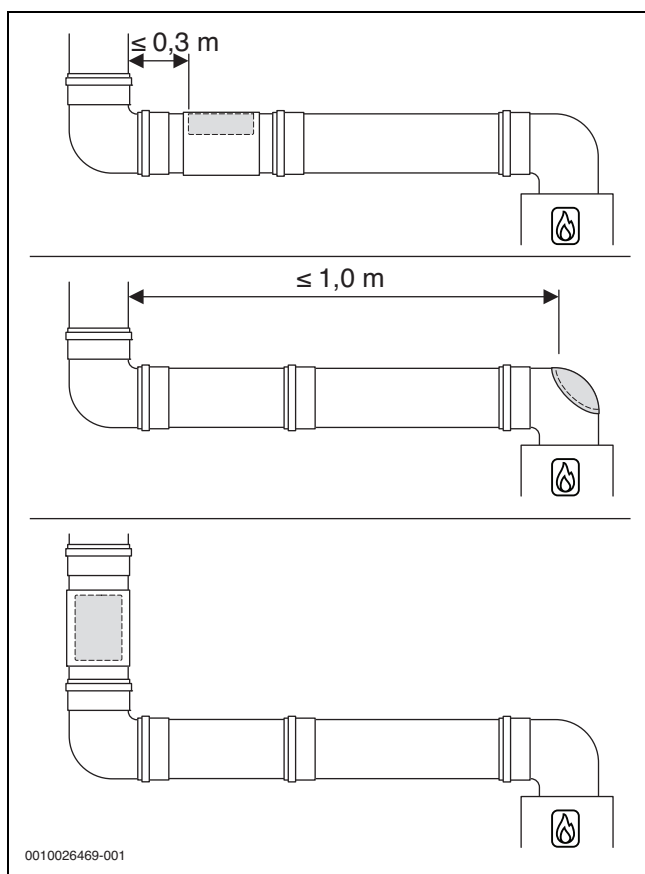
disposizione dell'apertura d'ispezione inferiore
